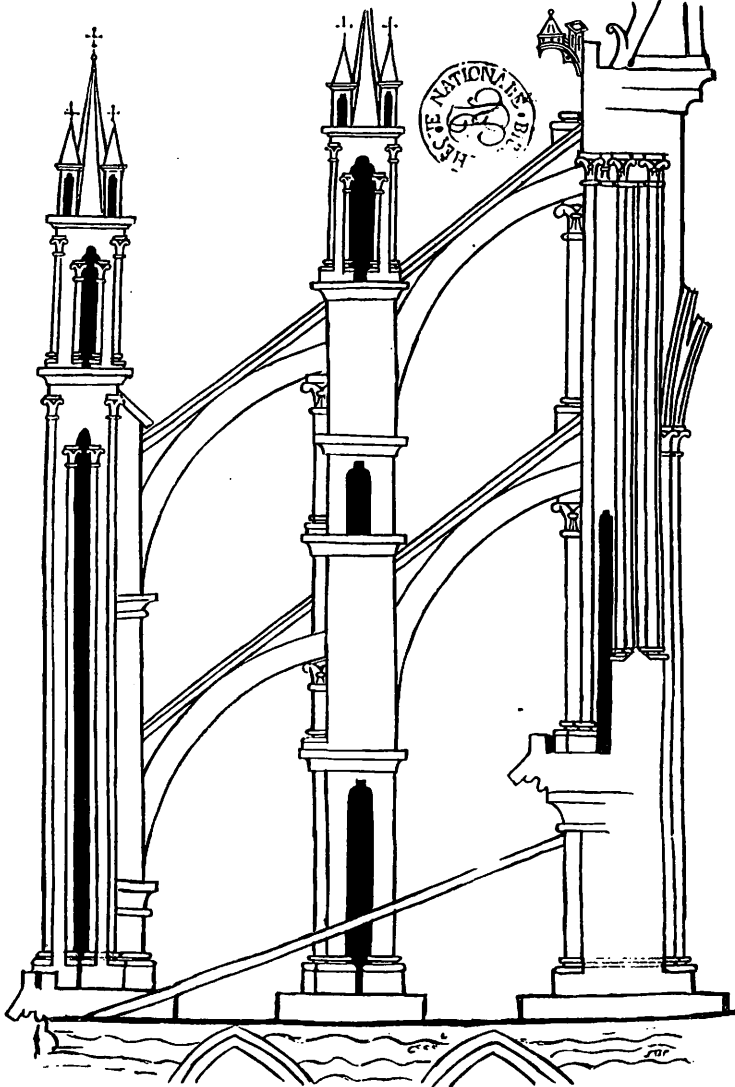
Dans les carnets de Villard de Honnecourt, la planche représentant en coupe un projet de la cathédrale de Reims situe trop bas l'arc-boutant inférieur qui doit reprendre la poussée de la voûte.
